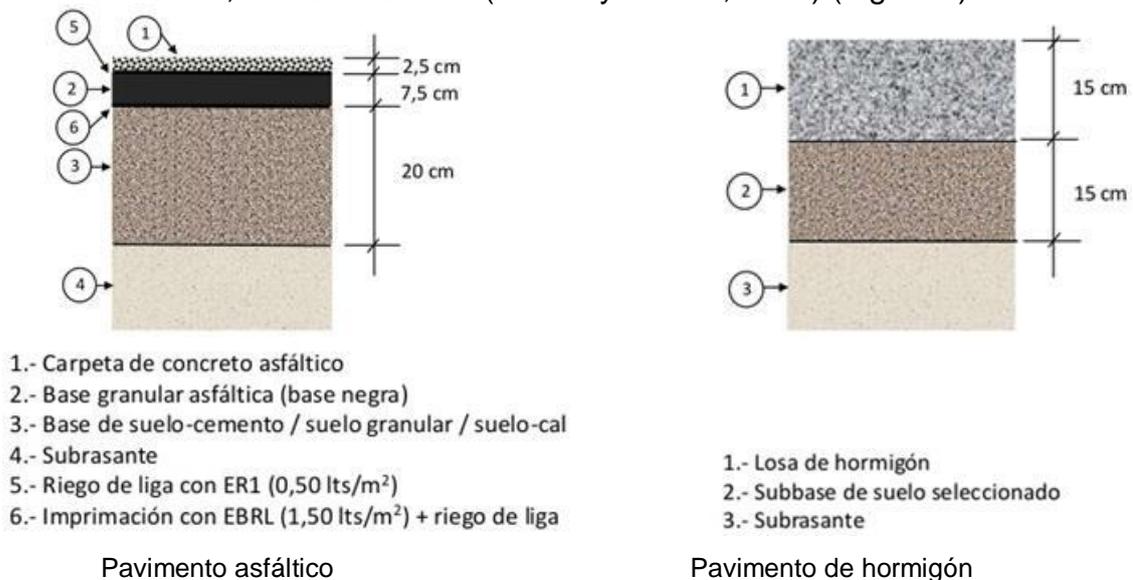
Paquetes estructurales típicos de pavimento asfáltico y de hormigón.
